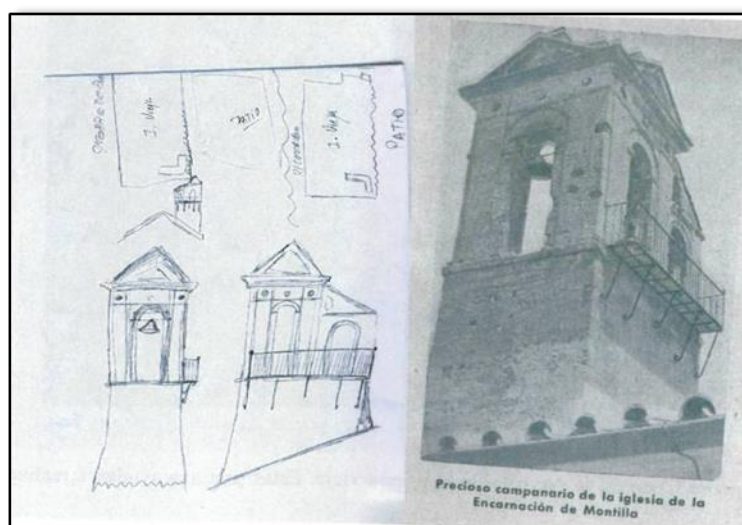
Torre del padre Copado y dibujo a mano alzada de planta, alzado y perfil.
